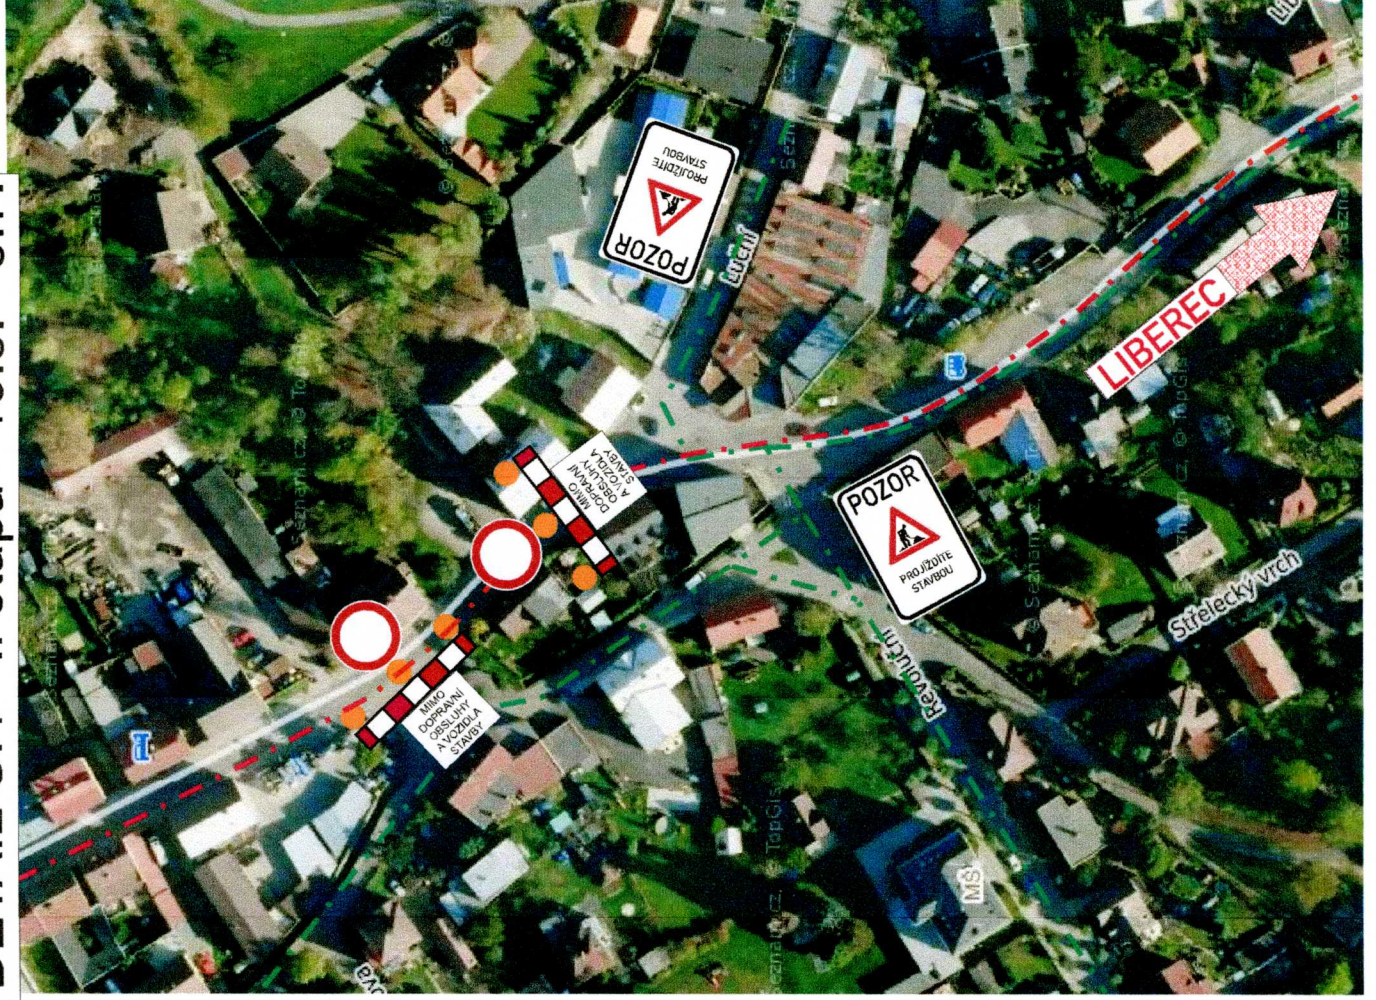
II. etapa - 6.7. - 15.11.
